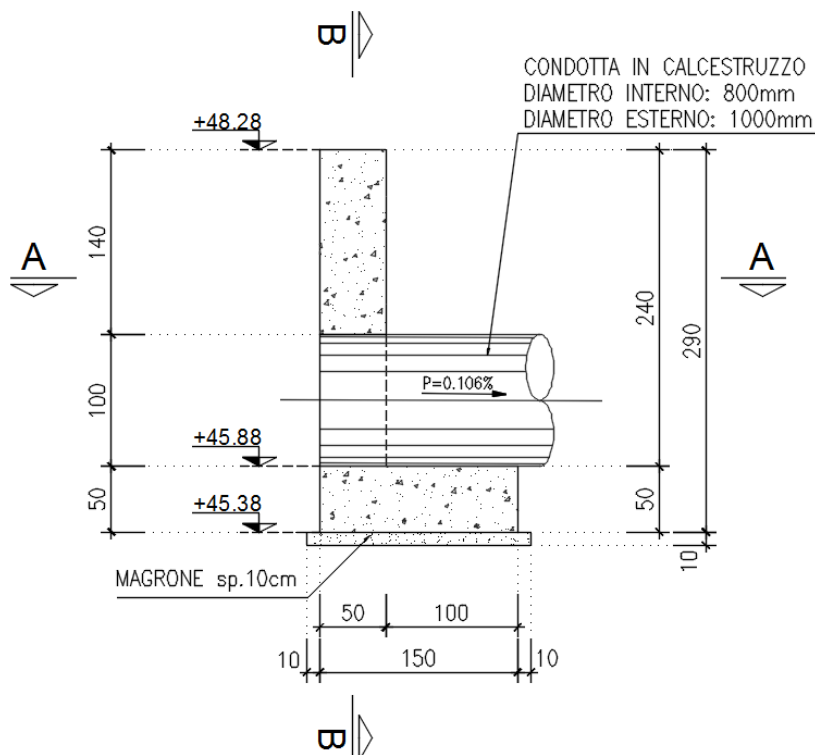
Sezione di calcolo del muro di connessione idraulica NV54 (pk 0+380.00)
